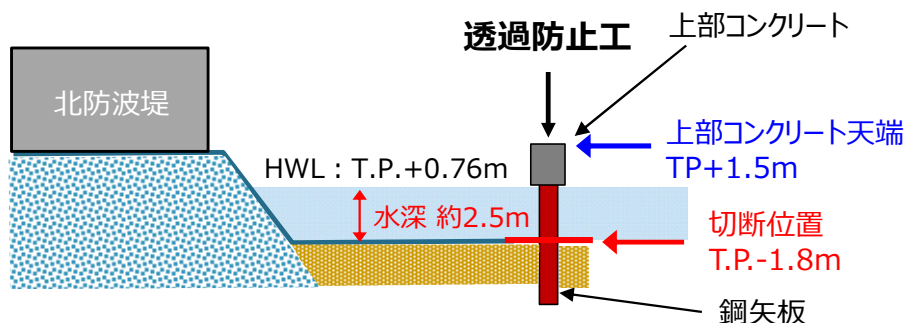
透過防止工改造断面図 (A-A 断面)
